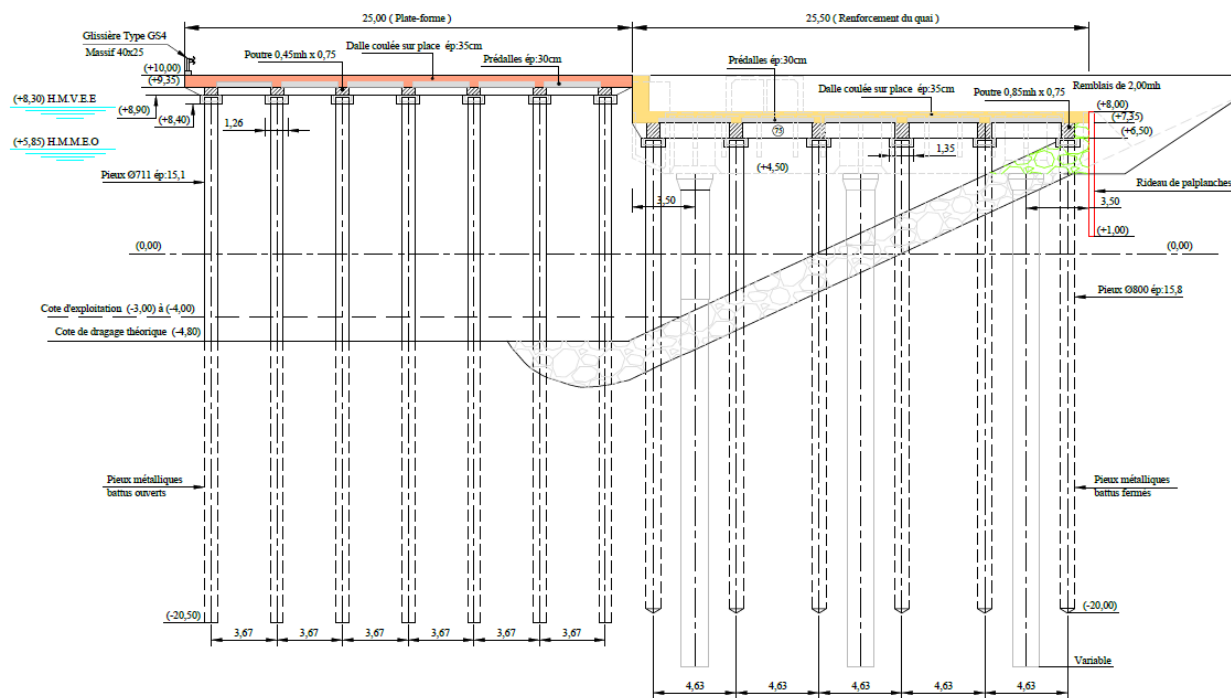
Coupe du renforcement du quai et de la rampe RORO
